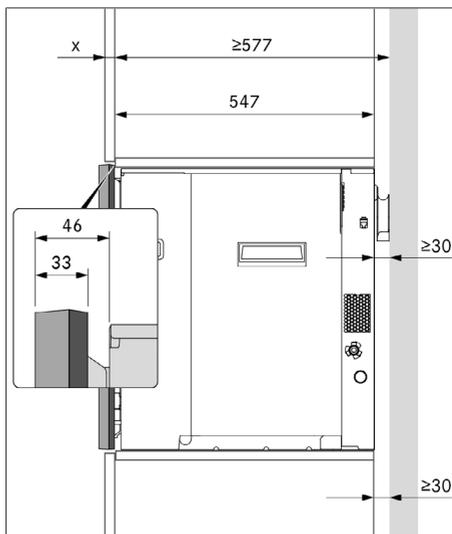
Dimensões de instalação com 1 estrutura de espaçamento
